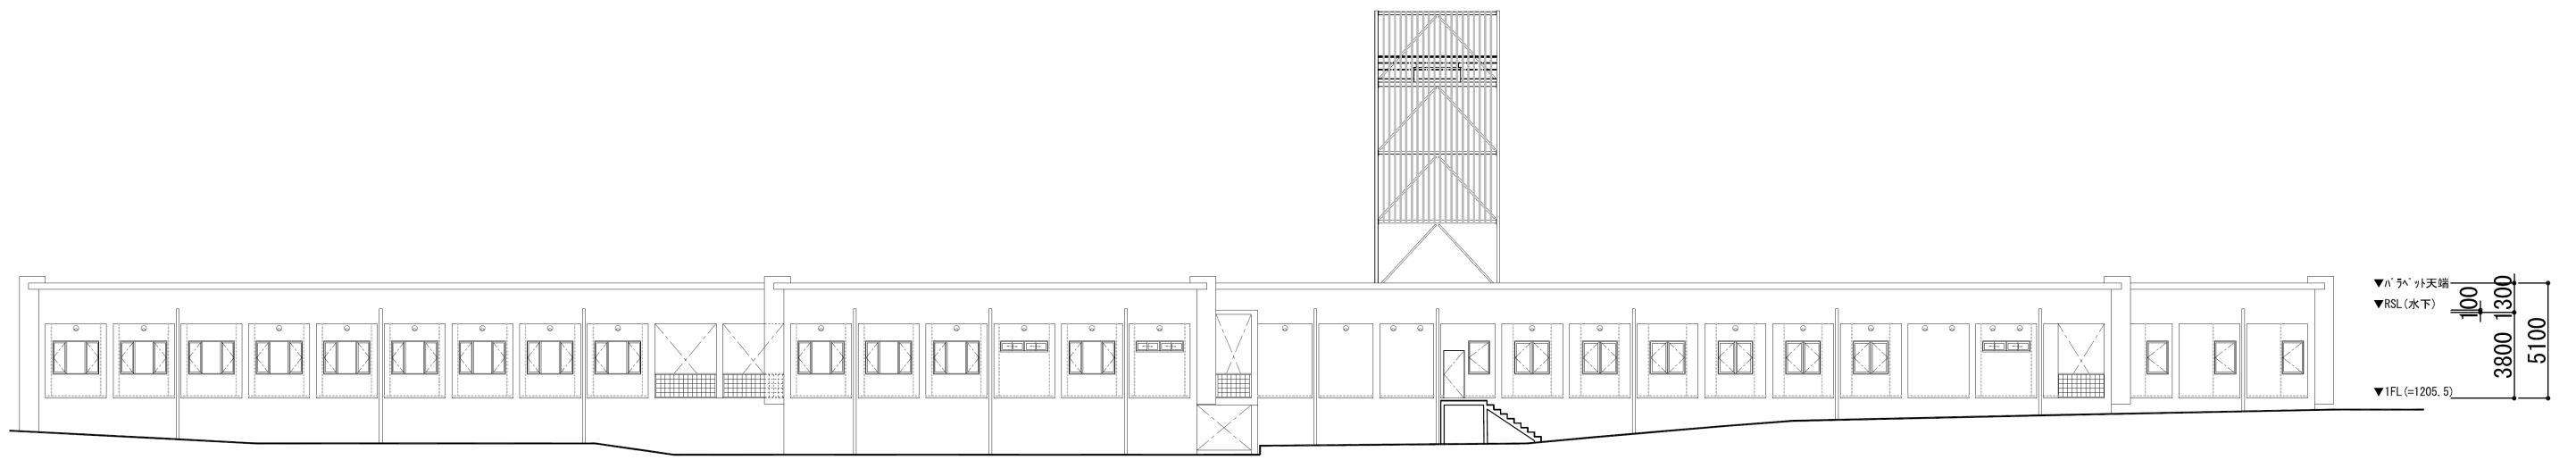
： チャンボリー次レベル病院 立面図-1 1/300
